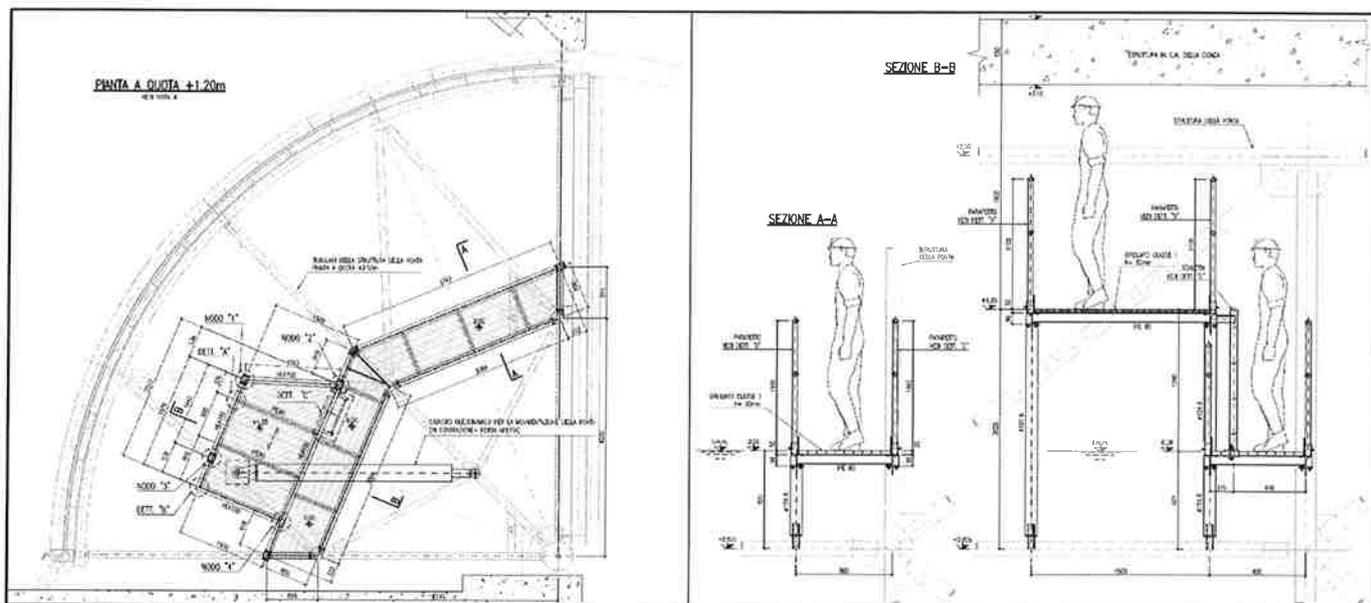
PEDANA DI ACCESSO AL PUNTO DI FISSAGGIO DEL CILINDRO
